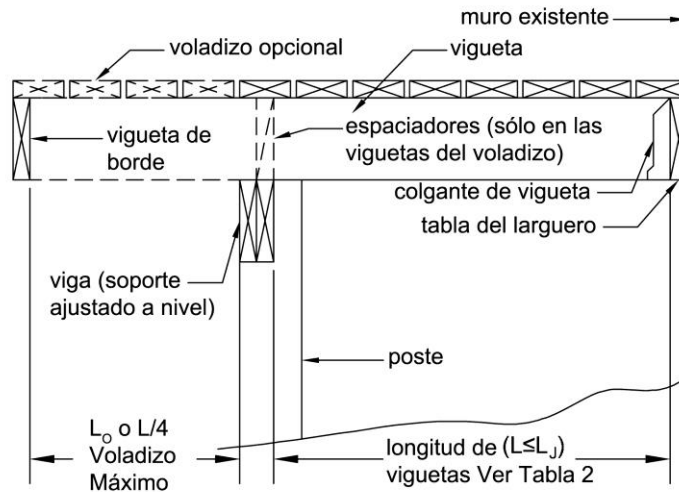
B. Longitud de Viguetas – Viguetas Unidas a una Casa y junto a una viga.
